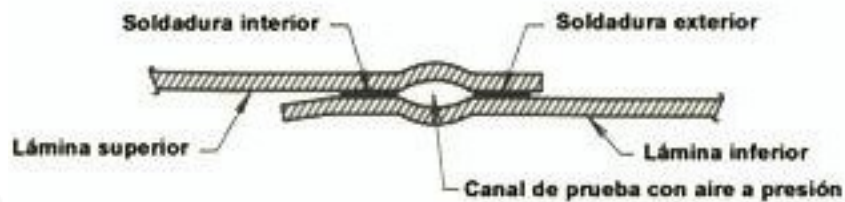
Soldadura doble por termo fusión con canal central de prueba
